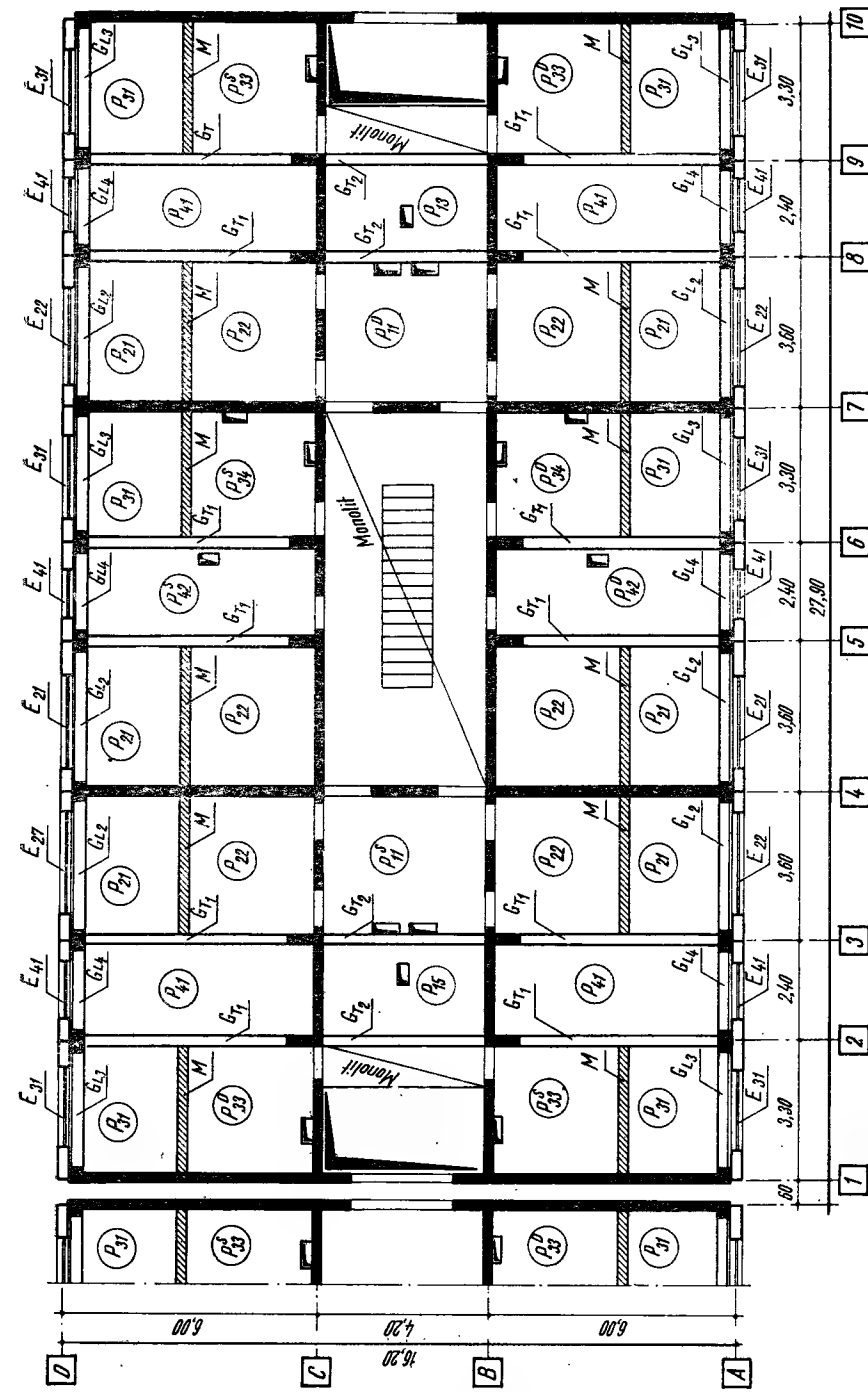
Plan poză prefabricate pentru o structură celulară, P + 4E, alcătuită din stâlpi și diafragme din beton armat monolit turnate în cofraje metalice plane, semipanouri prefabricate de planșeu care reazemă pe diafragme și pe grinzi prefabricate transversale și longitudinale și din panouri prefabricate pentru pereții exteriori.
